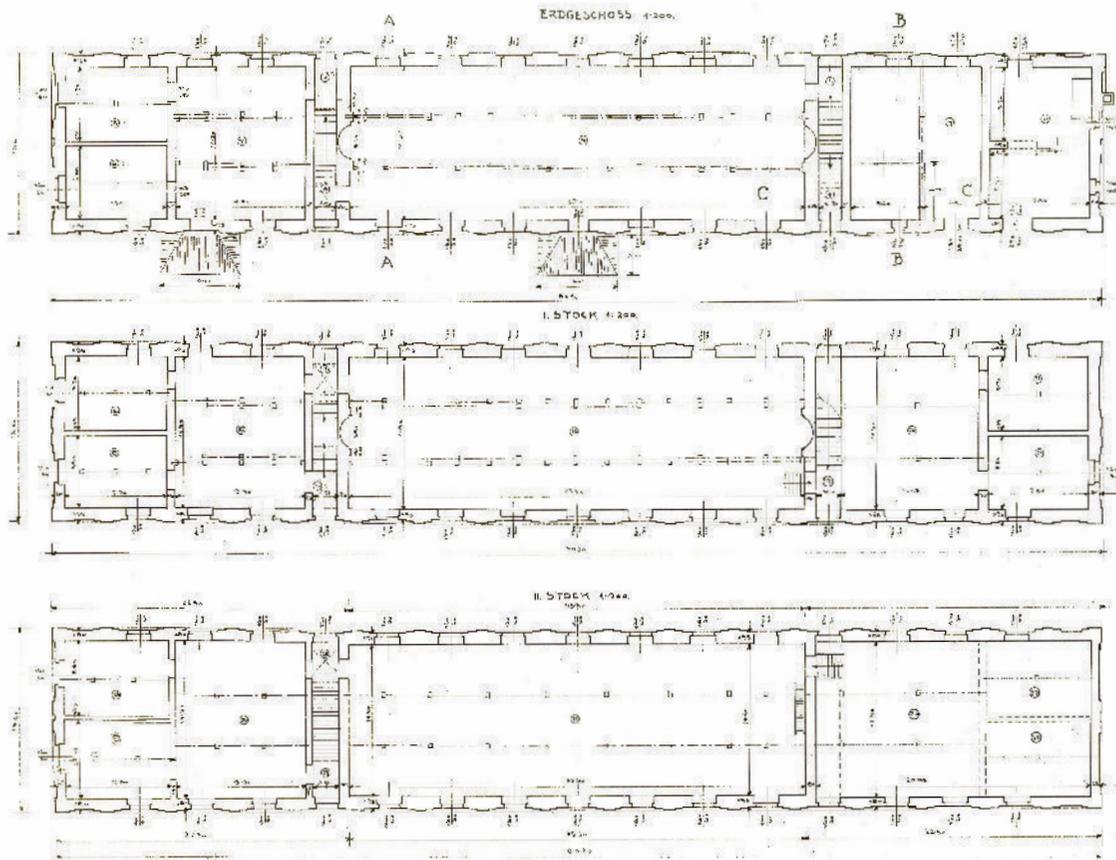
Grundrisse Schüttkasten/Granarium, ca. 1890
